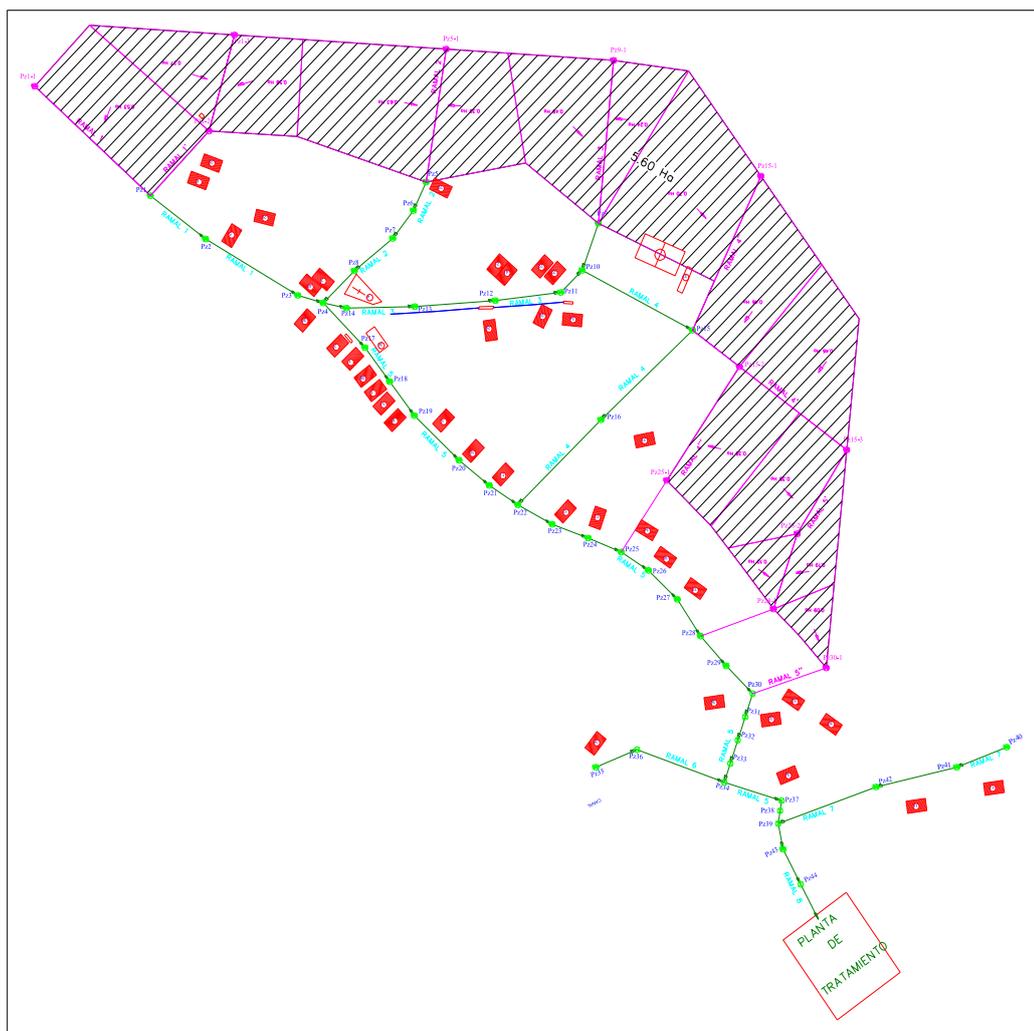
Áreas aportantes futuras del sistema de alcantarillado.
